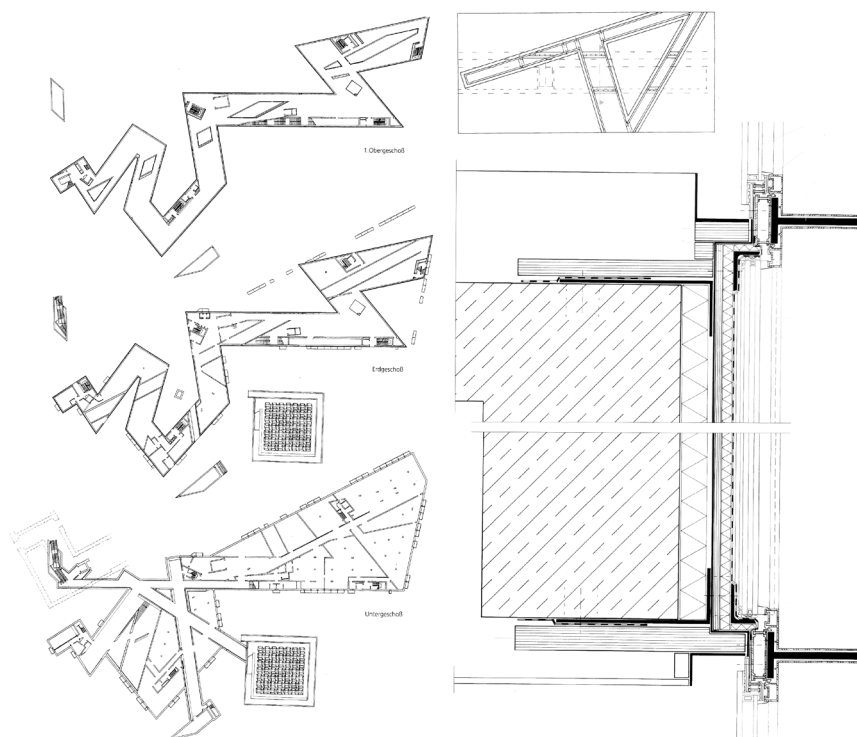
Möglichst exakte Zeichnungen sollen Fehler ausschließen und nichts dem Zufall überlassen: Grundrisse (M 1:1000 im Original) und Detail Zwischendecke (M 1:5 im Original) zum Jüdischen Museum Berlin von Daniel Libeskind
